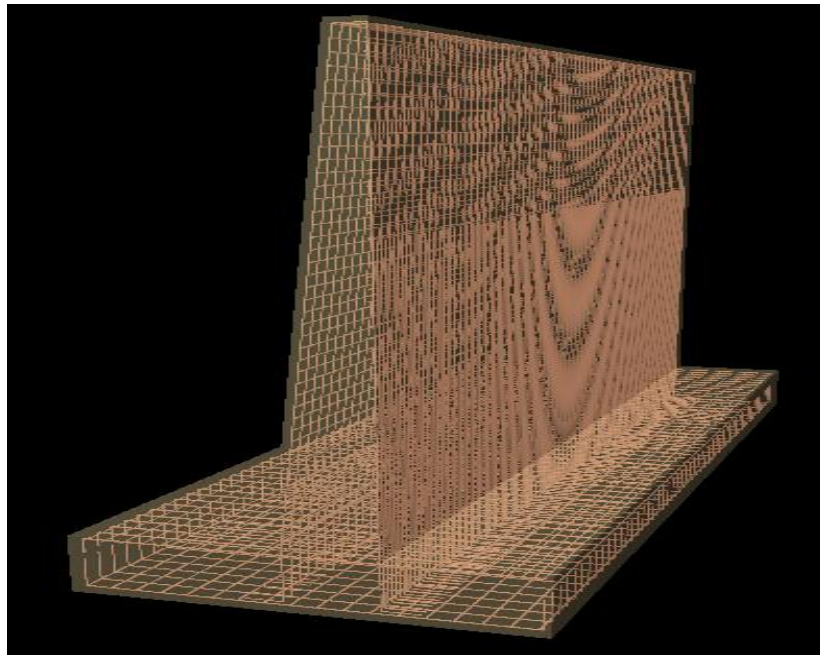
Vue sur l'interface de Structure mur soutènement (armature + béton+ matériaux) .
